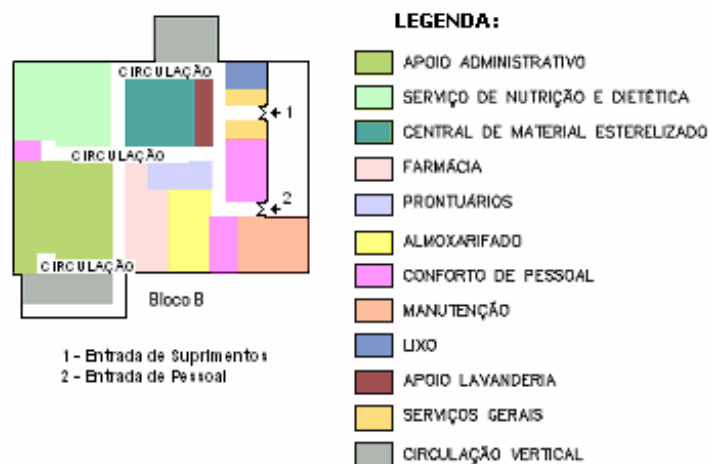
Setorização HU-CAS / UFJF (Pavimento Térreo)
